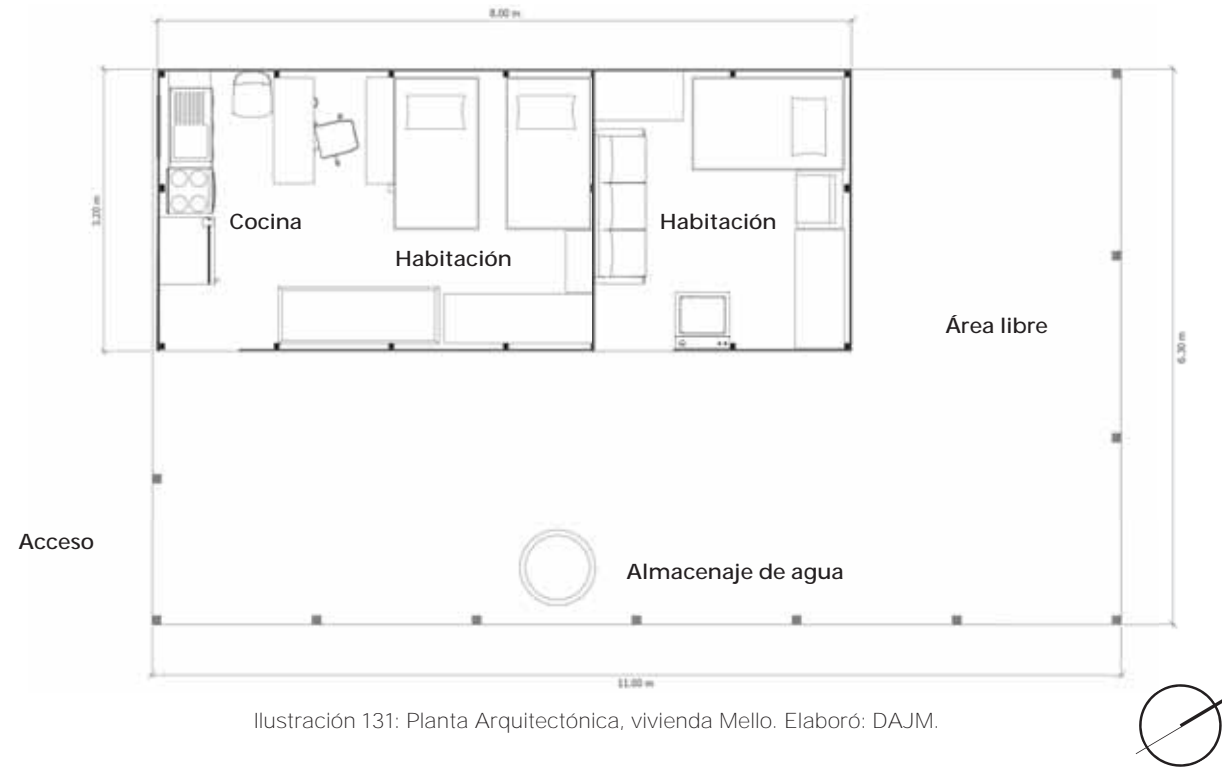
Planta Arquitectónica, vivienda Mello. Elaboró: DAJM.
